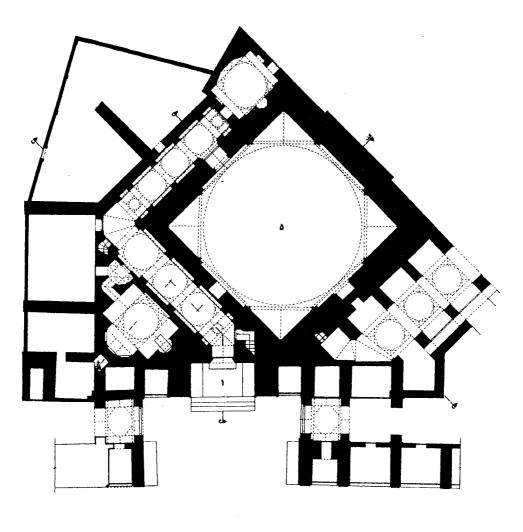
مسقط أفقي للمسجد الجديد (يني جامع) في كوموتيني باليونان (عن : كيل) .
